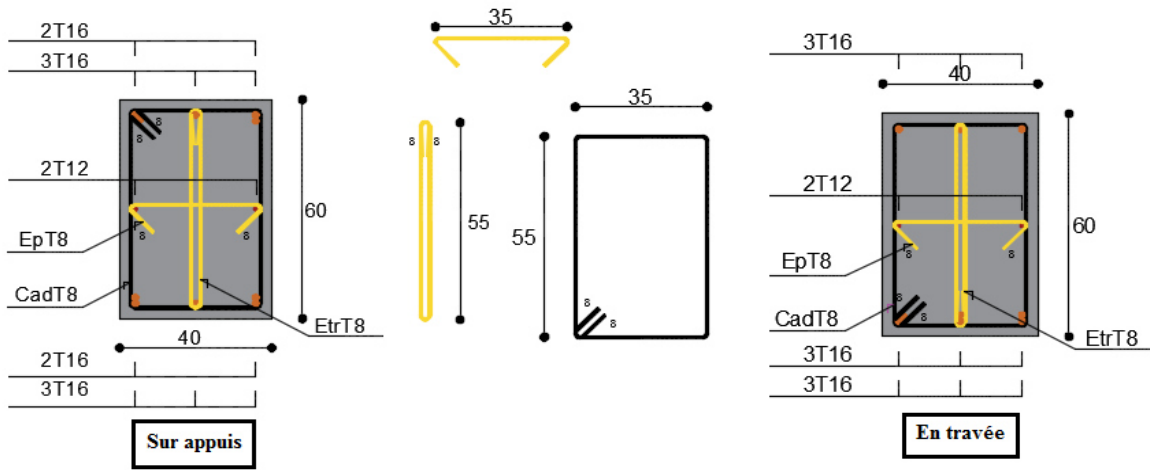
schéma de ferrailage des poutres principales en travée et en appuis (Bureau).
